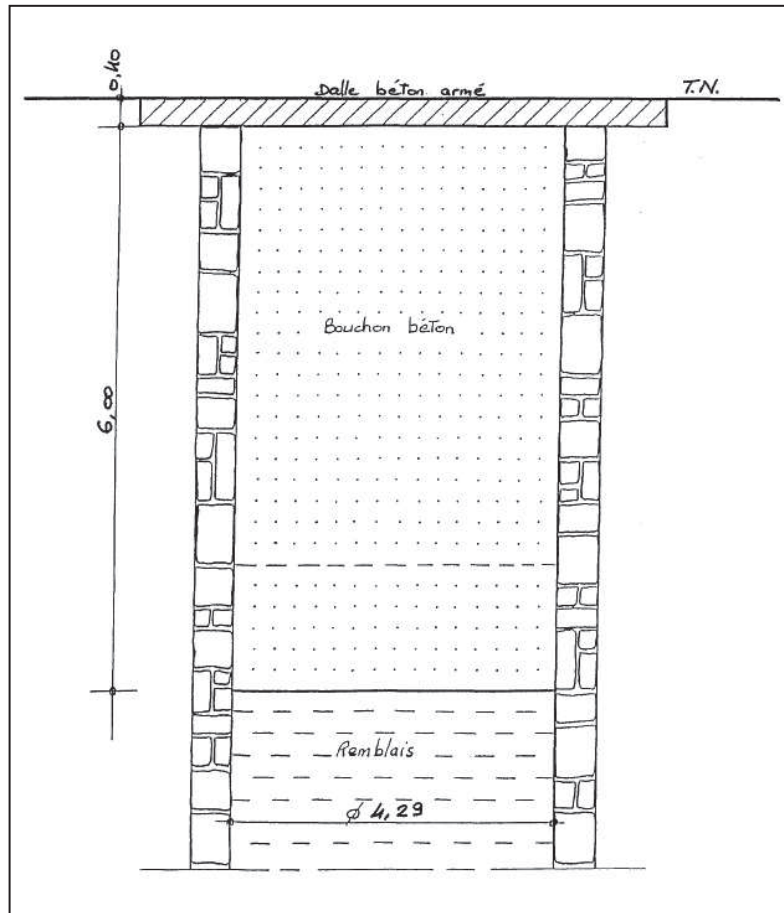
Schéma de mise en place du bouchon béton du puits du Parc
